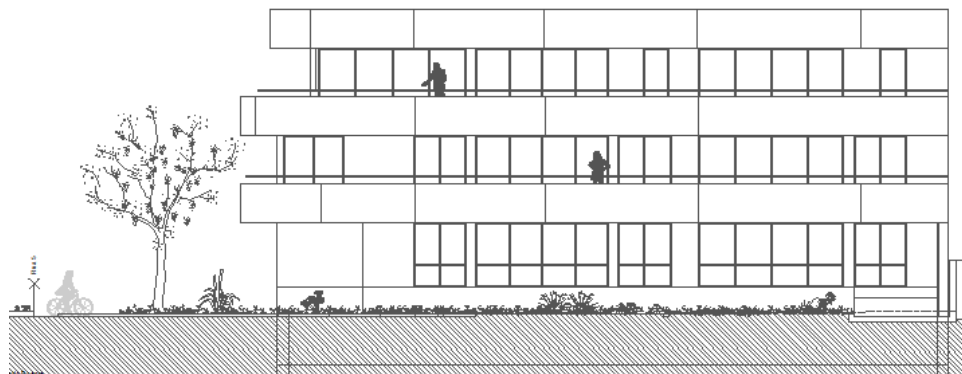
Alçado Poente da obra N°7 (1+1 Arquitectos, 2017).
